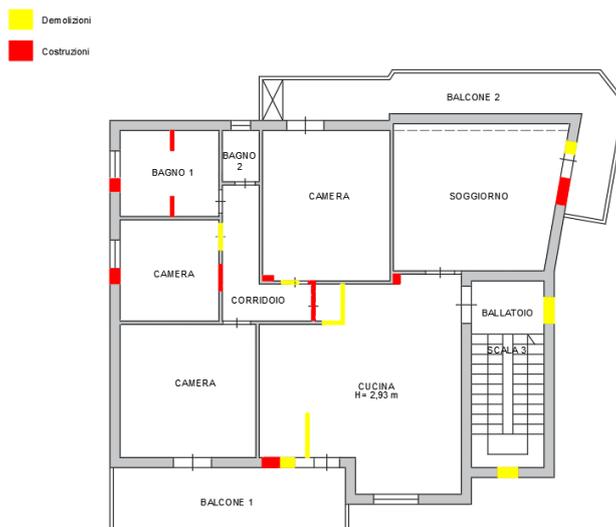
Confronto edilizio – Planimetria Piano Terra
